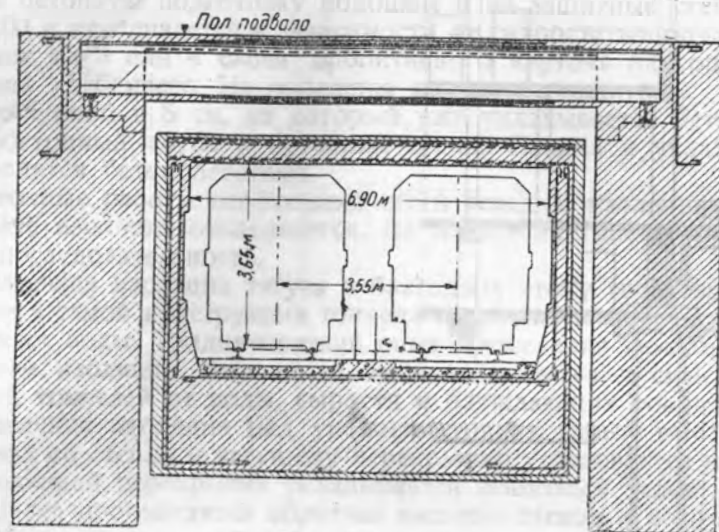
Ограждающая конструкция при проходке тоннеля метрополитена под зданием.
